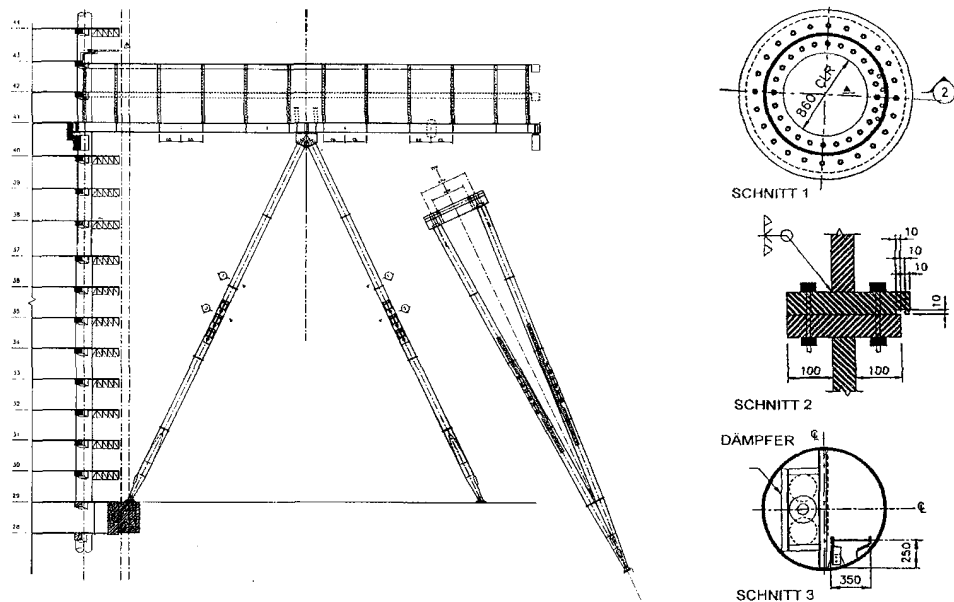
Ansicht der Außenbrücke und Details der Konstruktion [10.24, 10.35]
